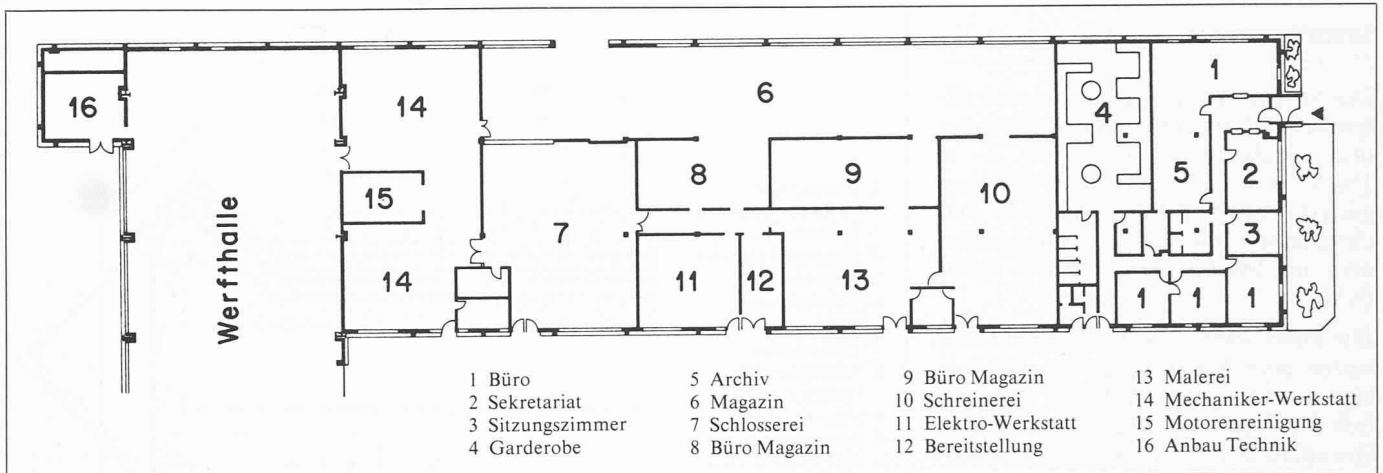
Grundriss Betriebsgebäude, mit Raumprogrammen
